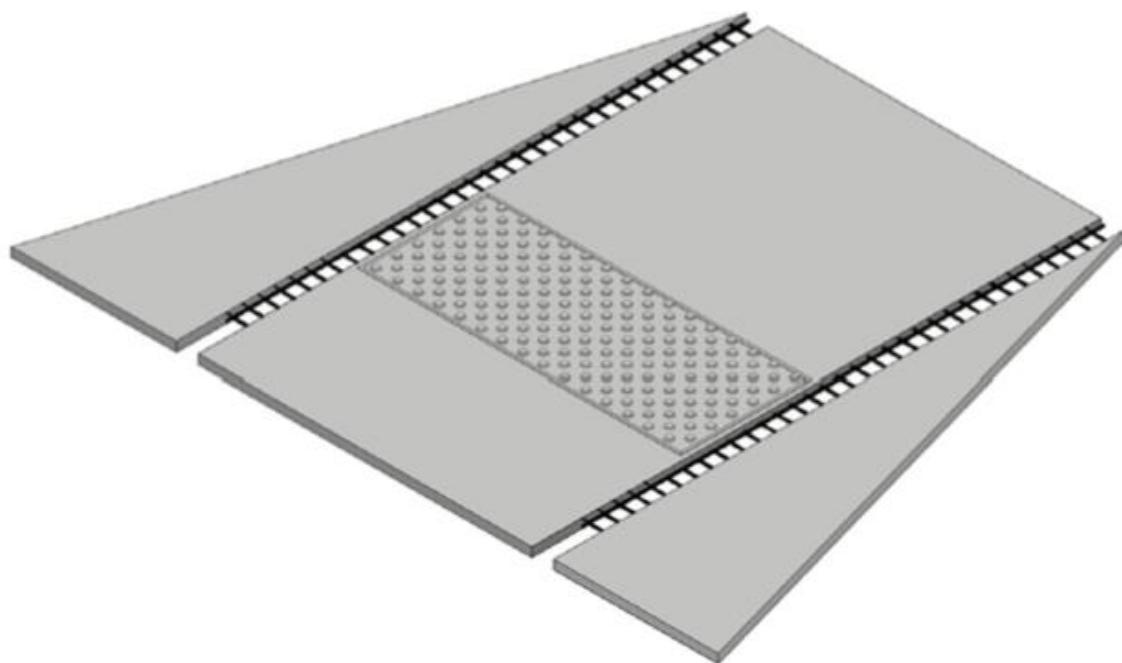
Desenho esquemático da rampa pré-fabricada especial após a desforma, onde é possível se observar às faixas de armadura sem cobrimento em microconcreto
